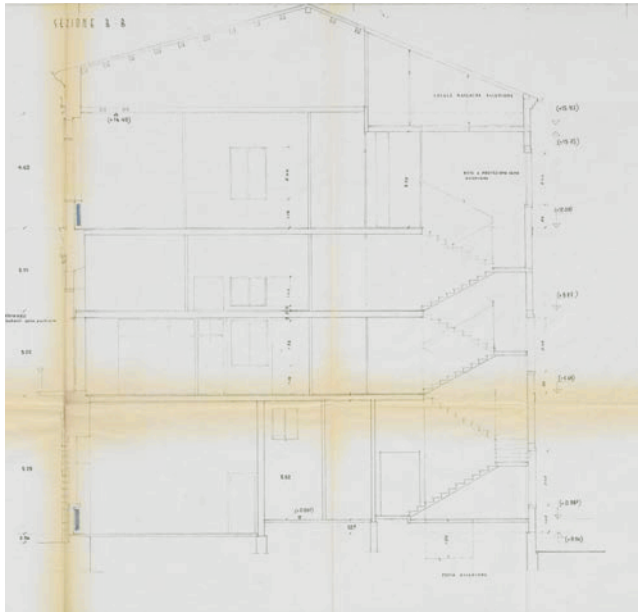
Estratto sezione B-B (1960) - (Archivio del Comune di Padova)
